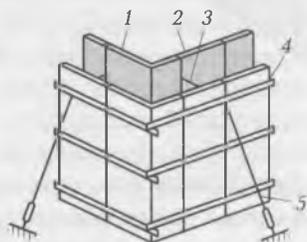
Опалубка угла стен из крупноразмерных щитов:
